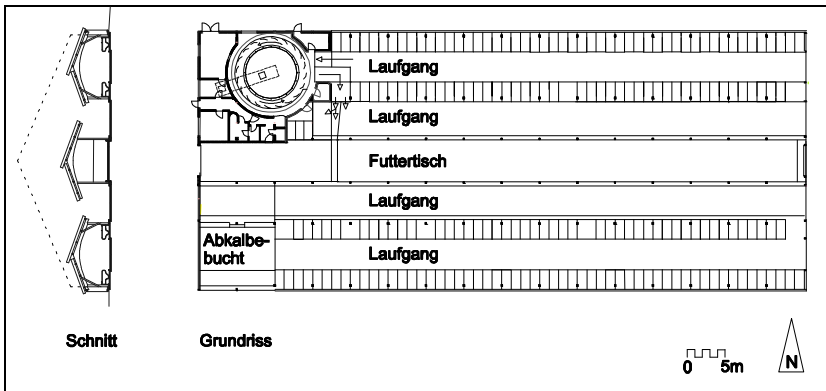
Grundriss und Schnitt des Betriebes Kűfner und Naiser, Bindlach.
